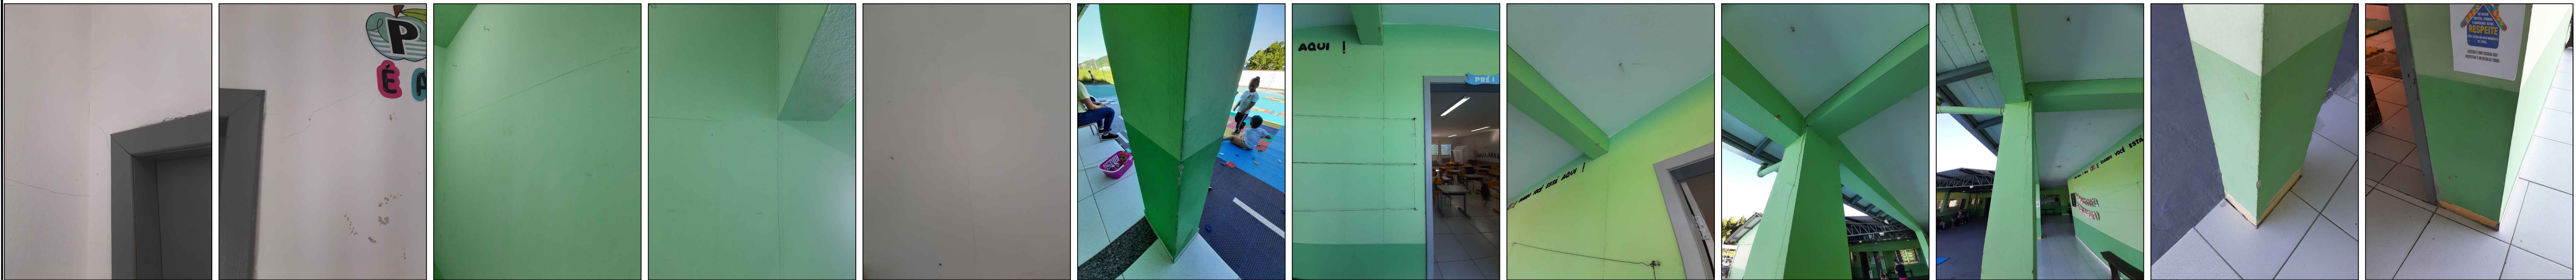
FOTO 62 FOTO 63 FOTO 64 FOTO 65 FOTO 66 FOTO 67 FOTO 68 FOTO 69 FOTO 70 FOTO 71 - INSTALAÇÃO DE RODAPÊ FOTO 72 - INSTALAÇÃO DE RODAPÊ
